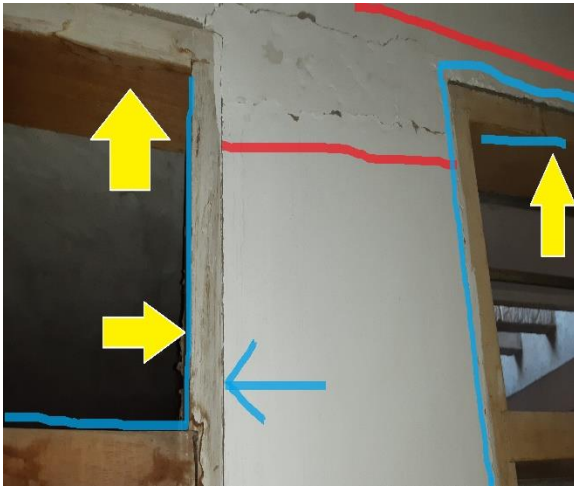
y 69: Afectacion de elementos estructurales y no estructurales, se evidencia la rotura del muro y la losa.
